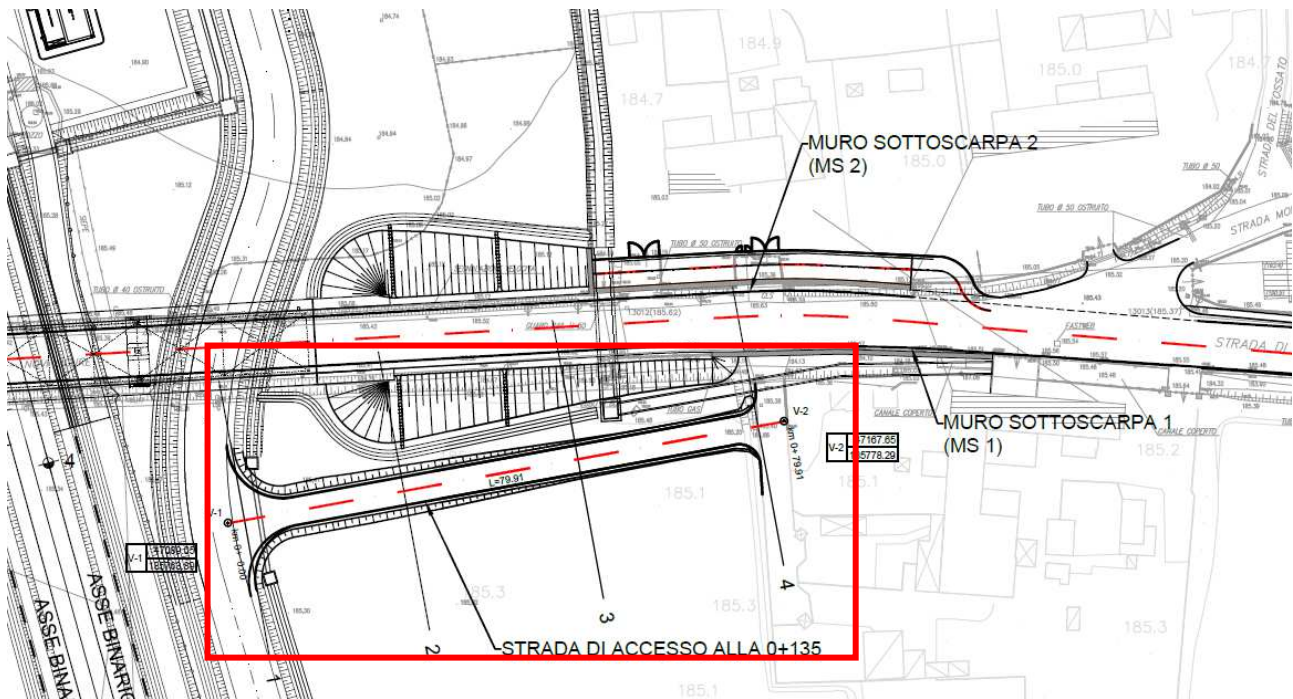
Stralcio planimetria dell'accesso alla 0+135
